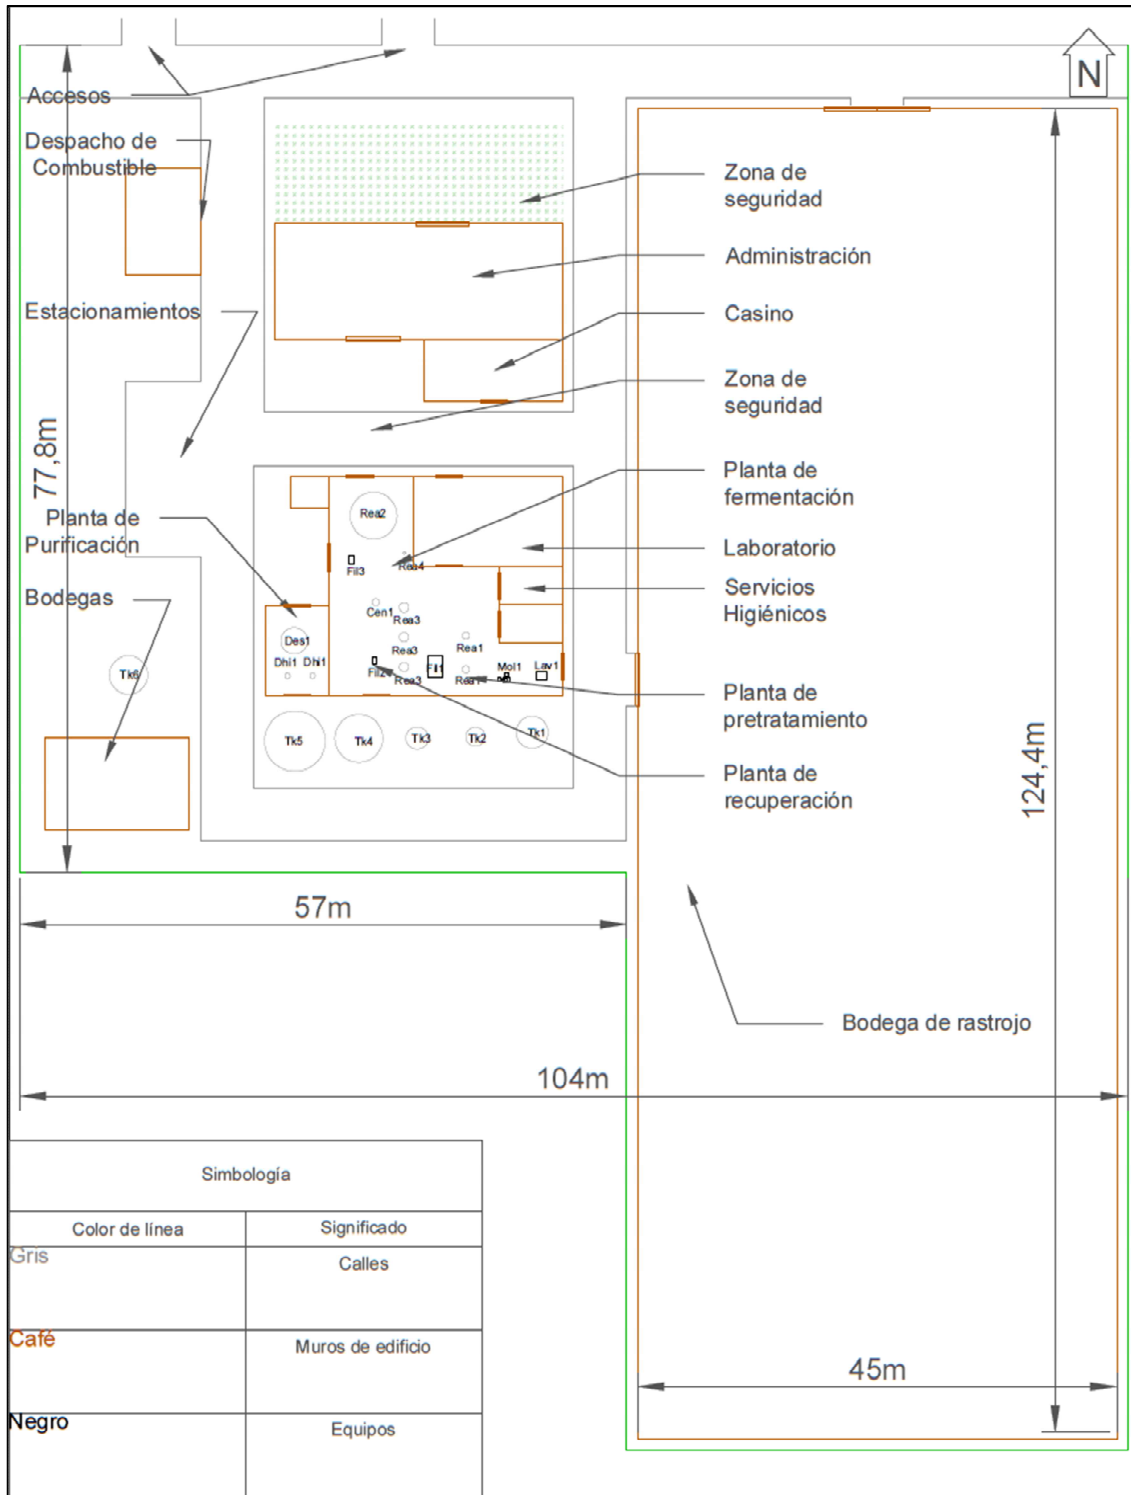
Layout general de la planta (incluyendo bodega de rastrojo)
